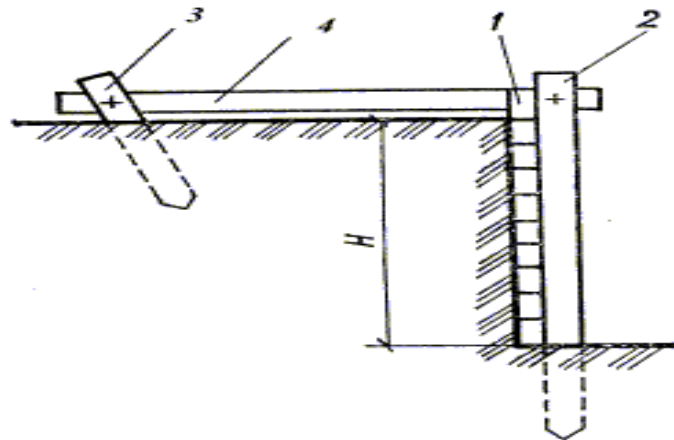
Анкерное крепление вертикальных стенок уступа: 1 — крепление уступа; 2 — стойка; 3 — анкер; 4 — затяжка
